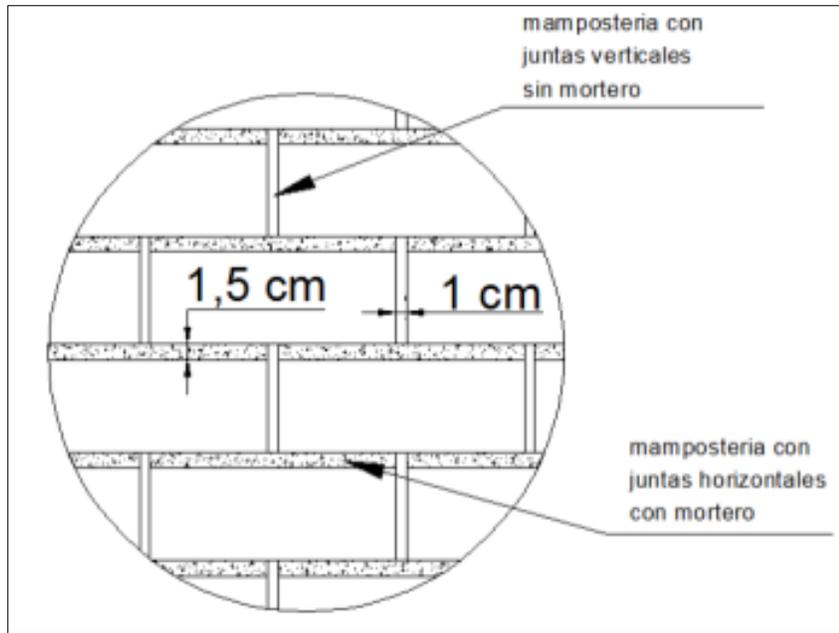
Detalle de las juntas verticales del pozo de percolación.
